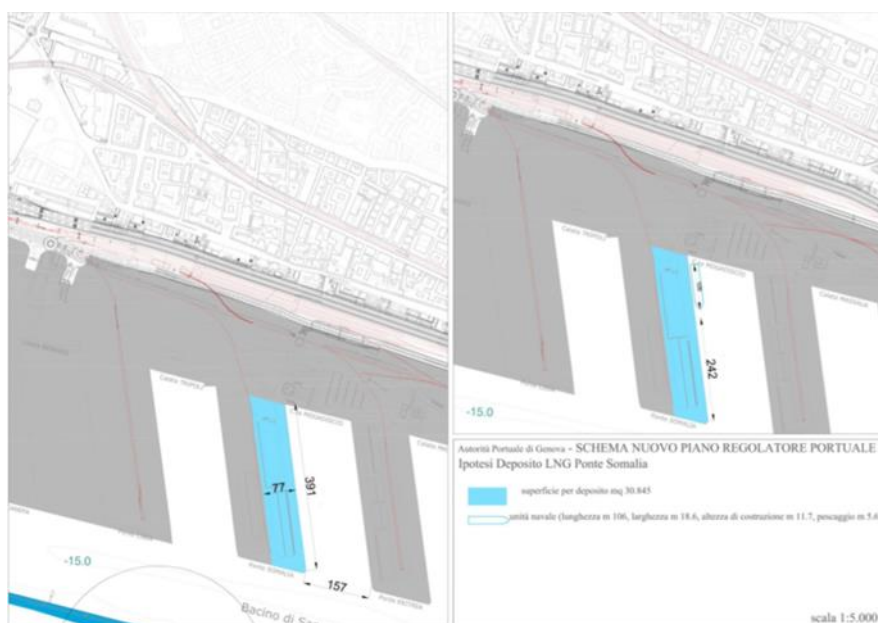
Layout ipotesi progettuale 6 (Fonte: report “Engineering studies, final version”)
